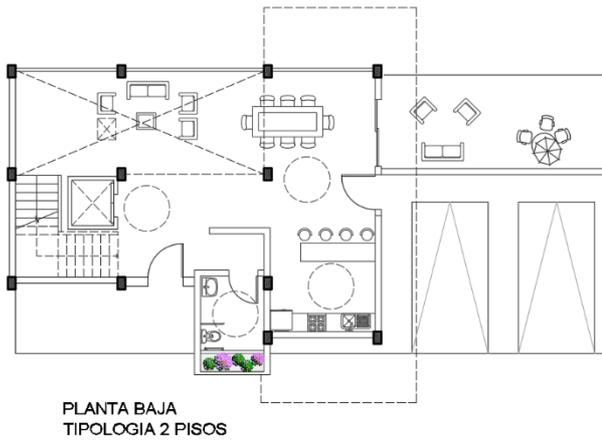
Planta baja tipología casa de 2 pisos. (Vinueza, B.)
